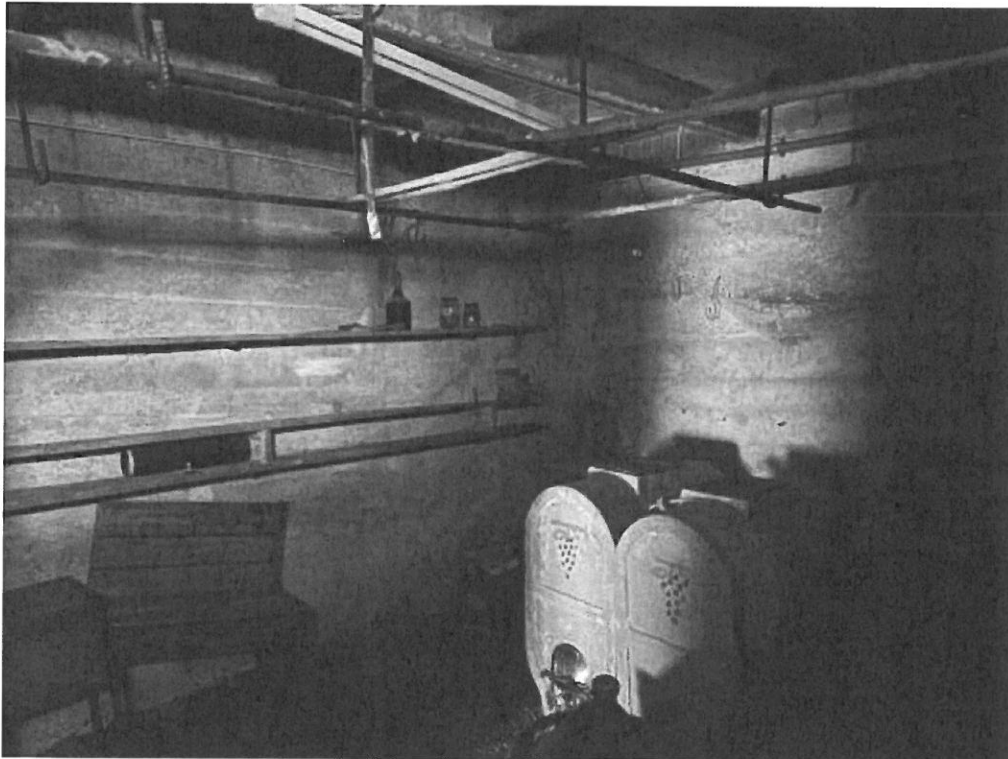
PS1 (sub. 3) deposito angolo Ovest
